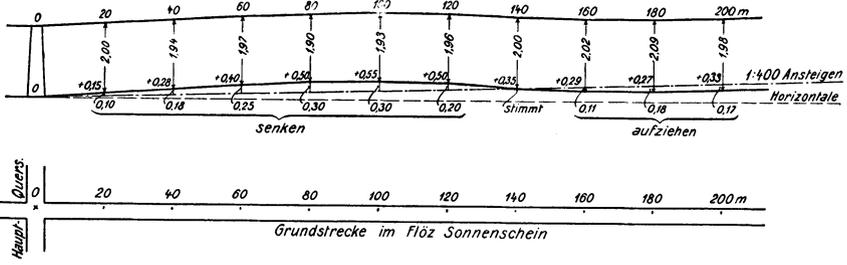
Nivellement einer Sohlenstrecke; oben Längenprofil, unten Grundriß.
